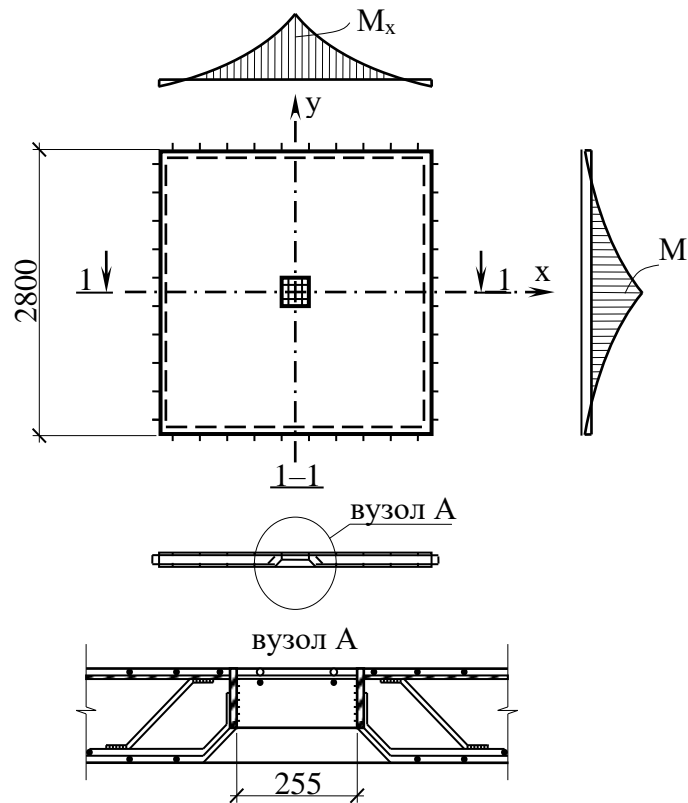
Схема каркаса з безбалковим безкапітельним перекриттям:
